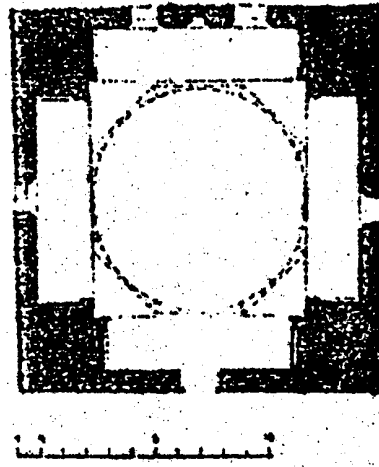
مسقط أفقي لقبة الأشرف خليل بالقاهرة
